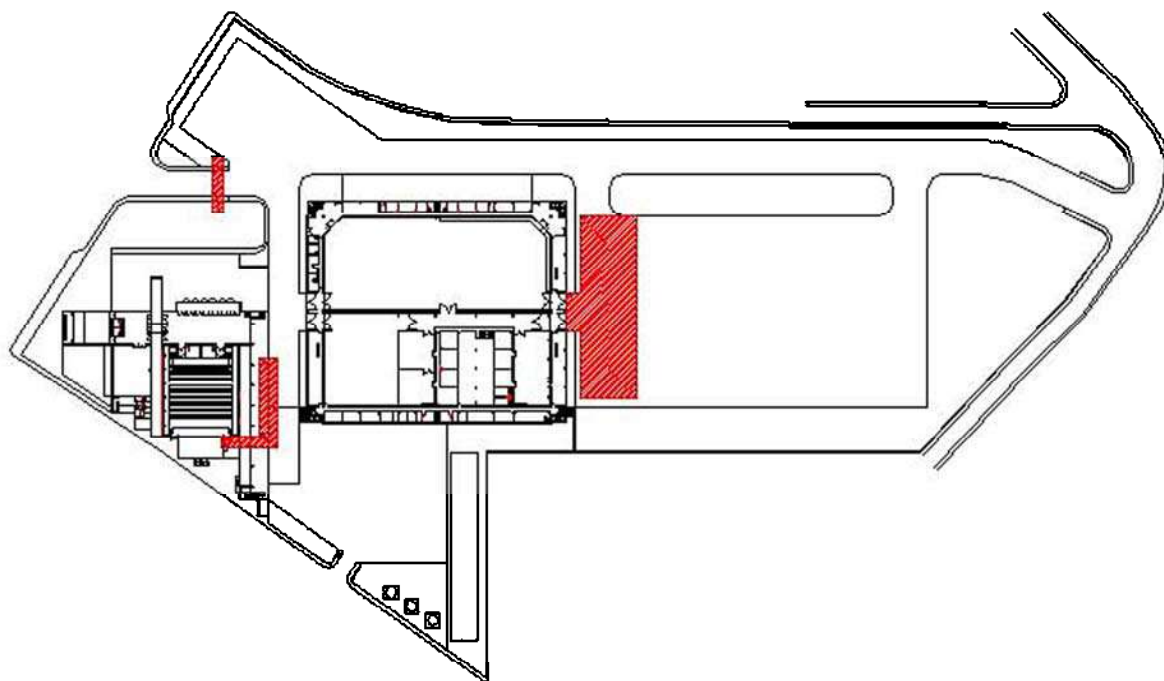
Planta do Conjunto Vera Cruz com proposta de demolição (em vermelho).
